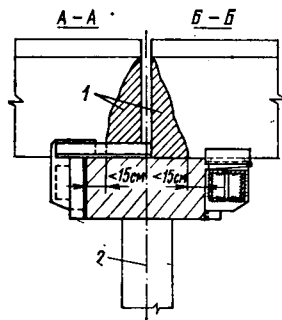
Неправильное размещение балок пролетных строений на насадке опоры
